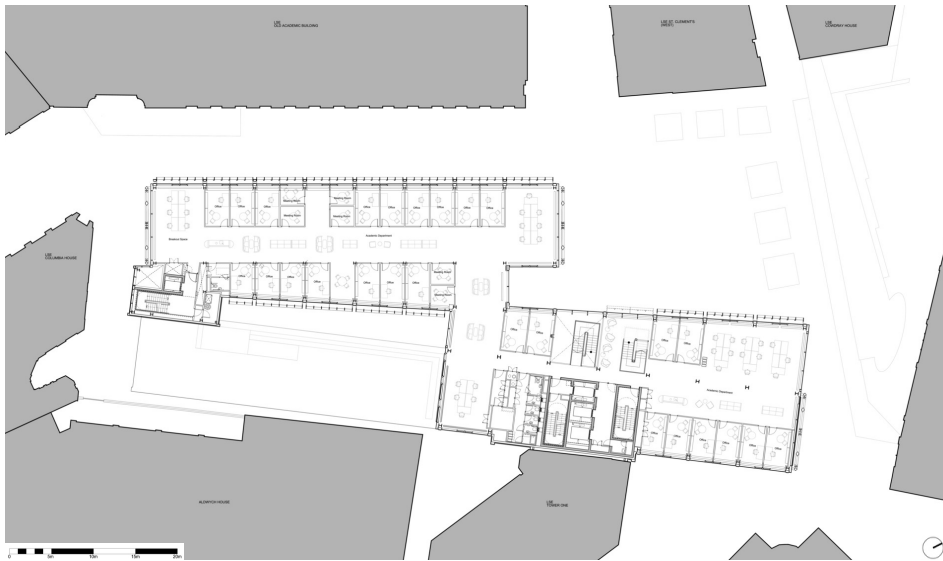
LSE Centre Building | Planta do 4º e 5º Pavimento
